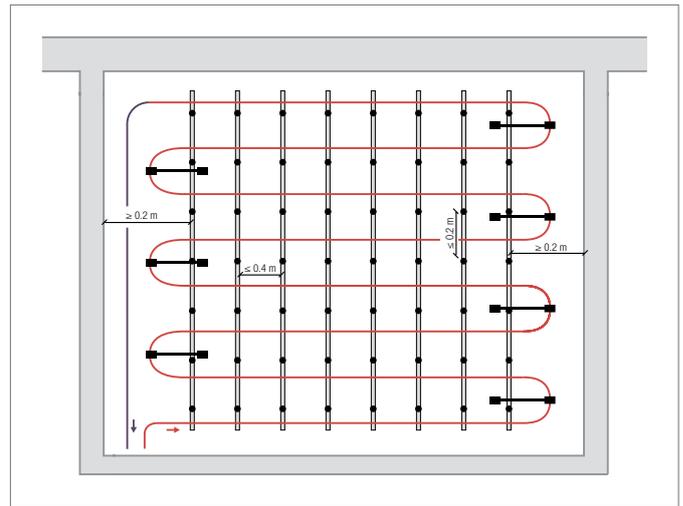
Version à simple méandre, VA 10 (vue de dessus de la surface du sol)
